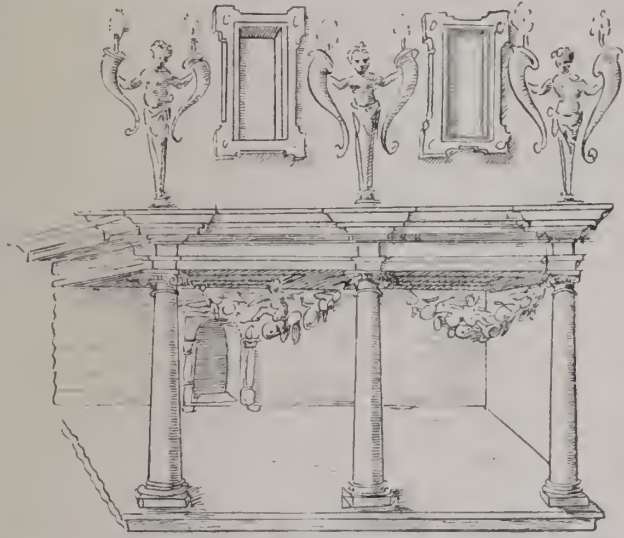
Mailand, Offene Hausflur mit Säulen nebst verziertem Obergeschoß
